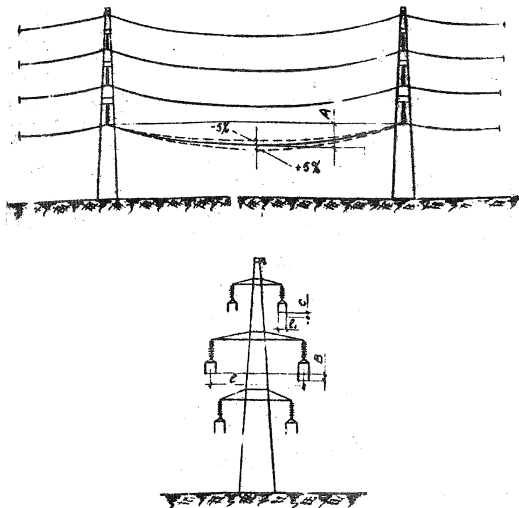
Нормы и допуски на монтаж проводов
